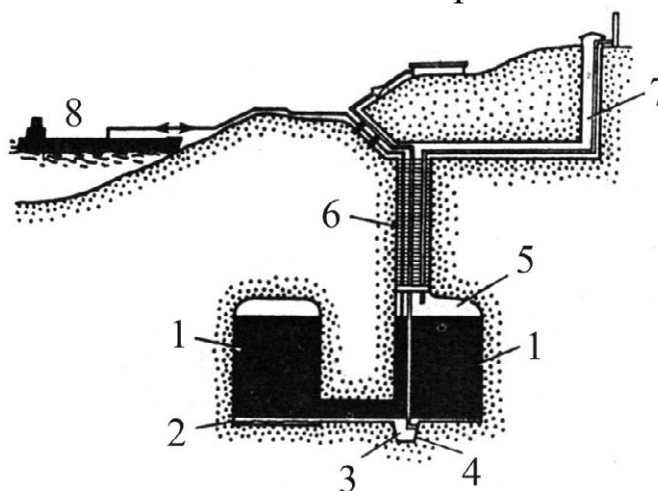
Вертикальный разрез подземного нефтехранилища (Франция)
